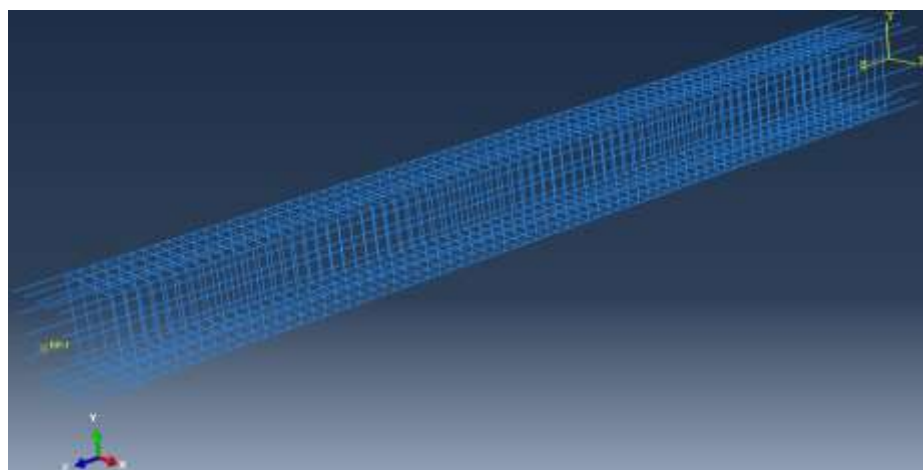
Representação tridimensional das armaduras de reforço da viga A2
